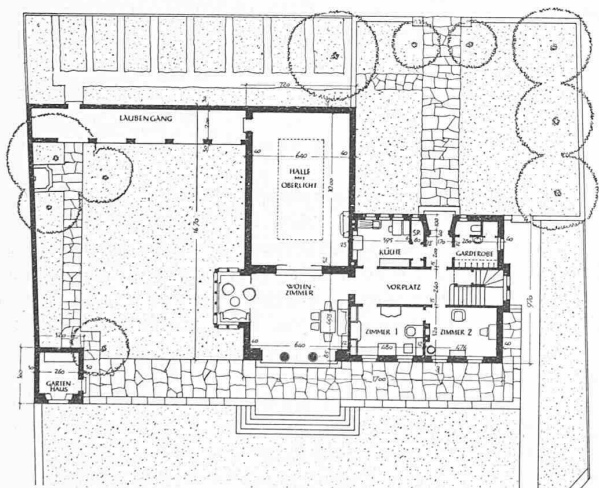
bis 6. Grundrisse vom Erdgeschoss, Obergeschoss und Untergeschoss 1:450 des Landhauses in Rüschiikon. — Arch. Vogelsanger & Maurer, Rüschiikon.
